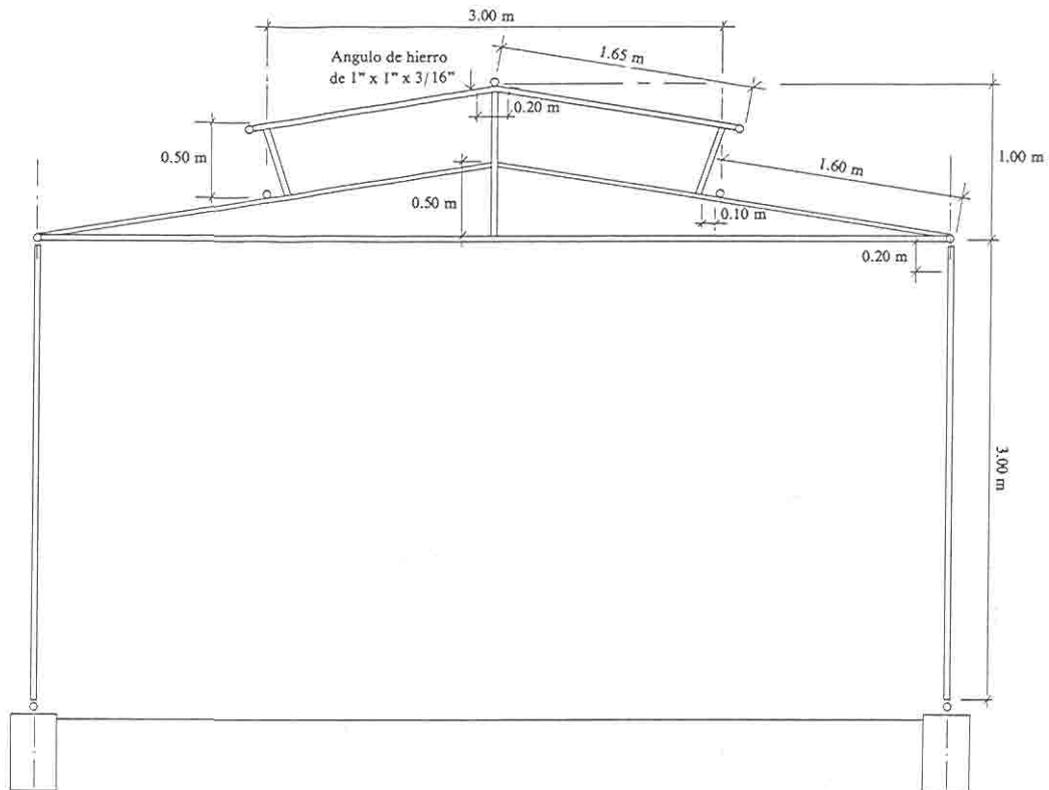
Plano de fachada ampliada de la casa de malla de tipo II; detalles constructivos. Diseño: D. R. Laing y R. J. Segovia. Julio 1988.
